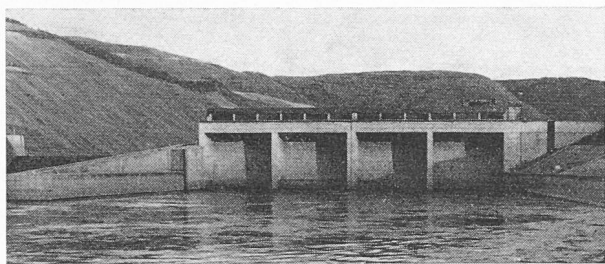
Barrage de Detzem vue aval ; la paroi en béton apparent est structurée par les piliers supportant la passerelle.
